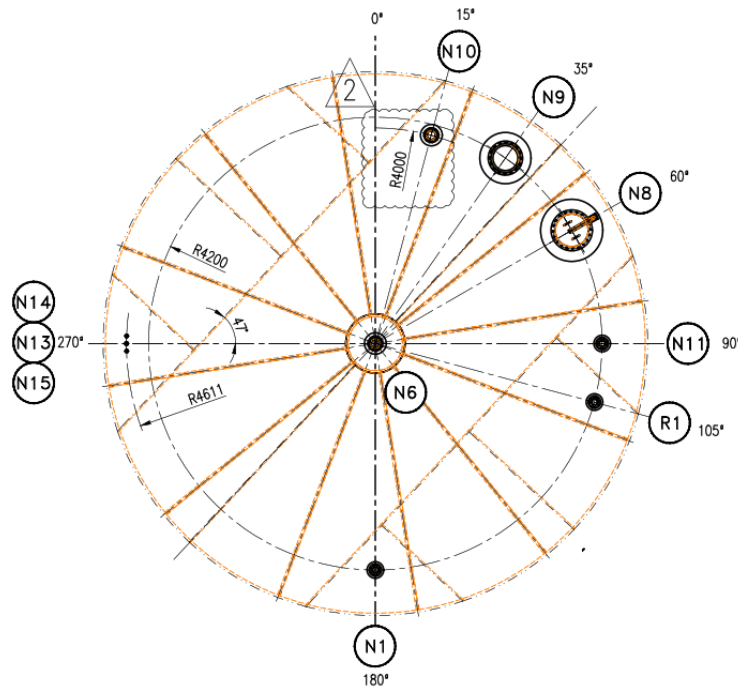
Montaje escalera helicoidal y barandas perimetrales de techo
